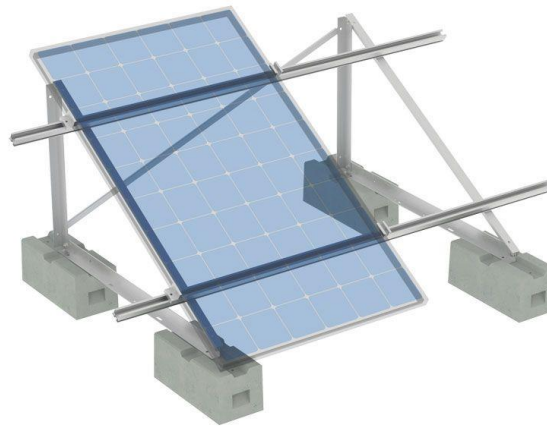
Conjunto estructural con lastres de hormigón similar al planteado en este proyecto.[Fuente: TEKNOMEGA^[17]]
